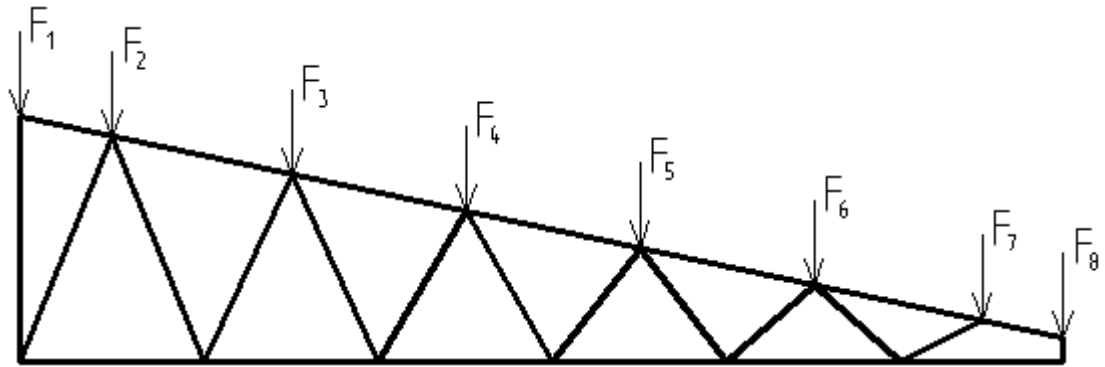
Схема загрузки фермы ФМ-1.
